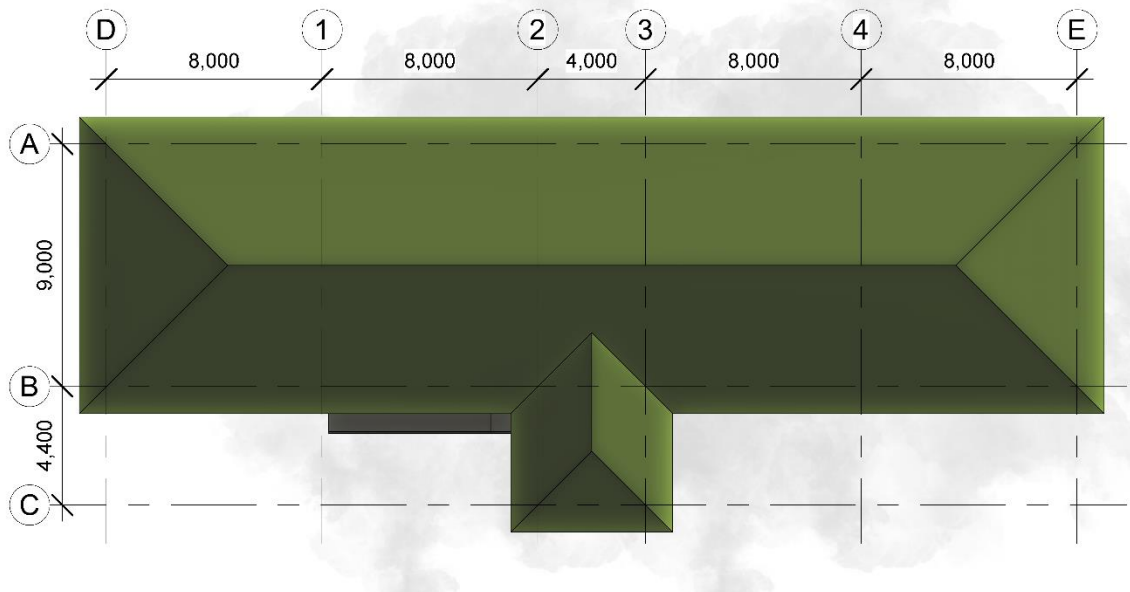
PLANTA DE TECHO EDIFICIO 2 | Elaborado por: El autor
